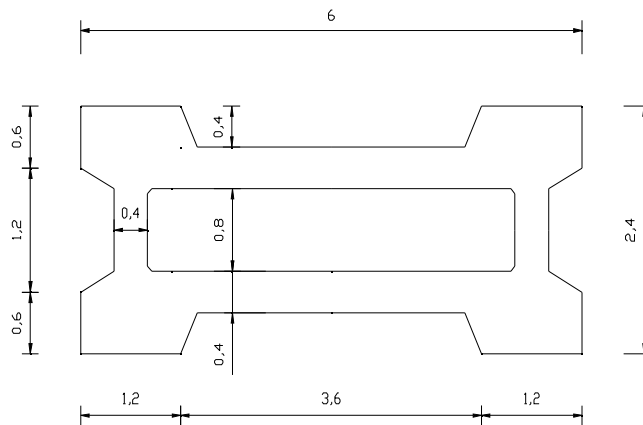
Secção dos pilares 1 a 5 e 9 a 17
